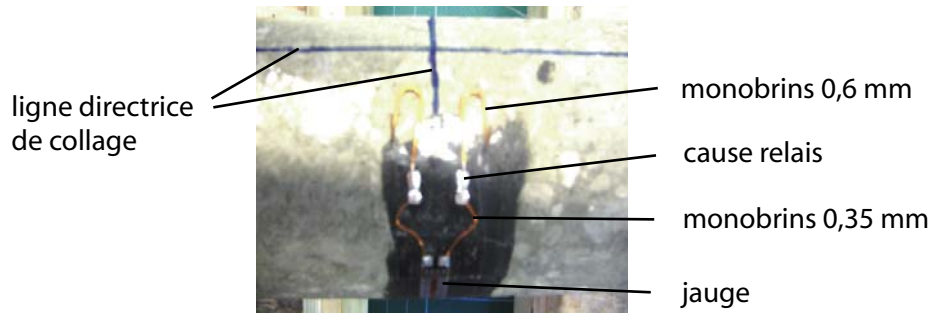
Soudage des deux types de monobrin
